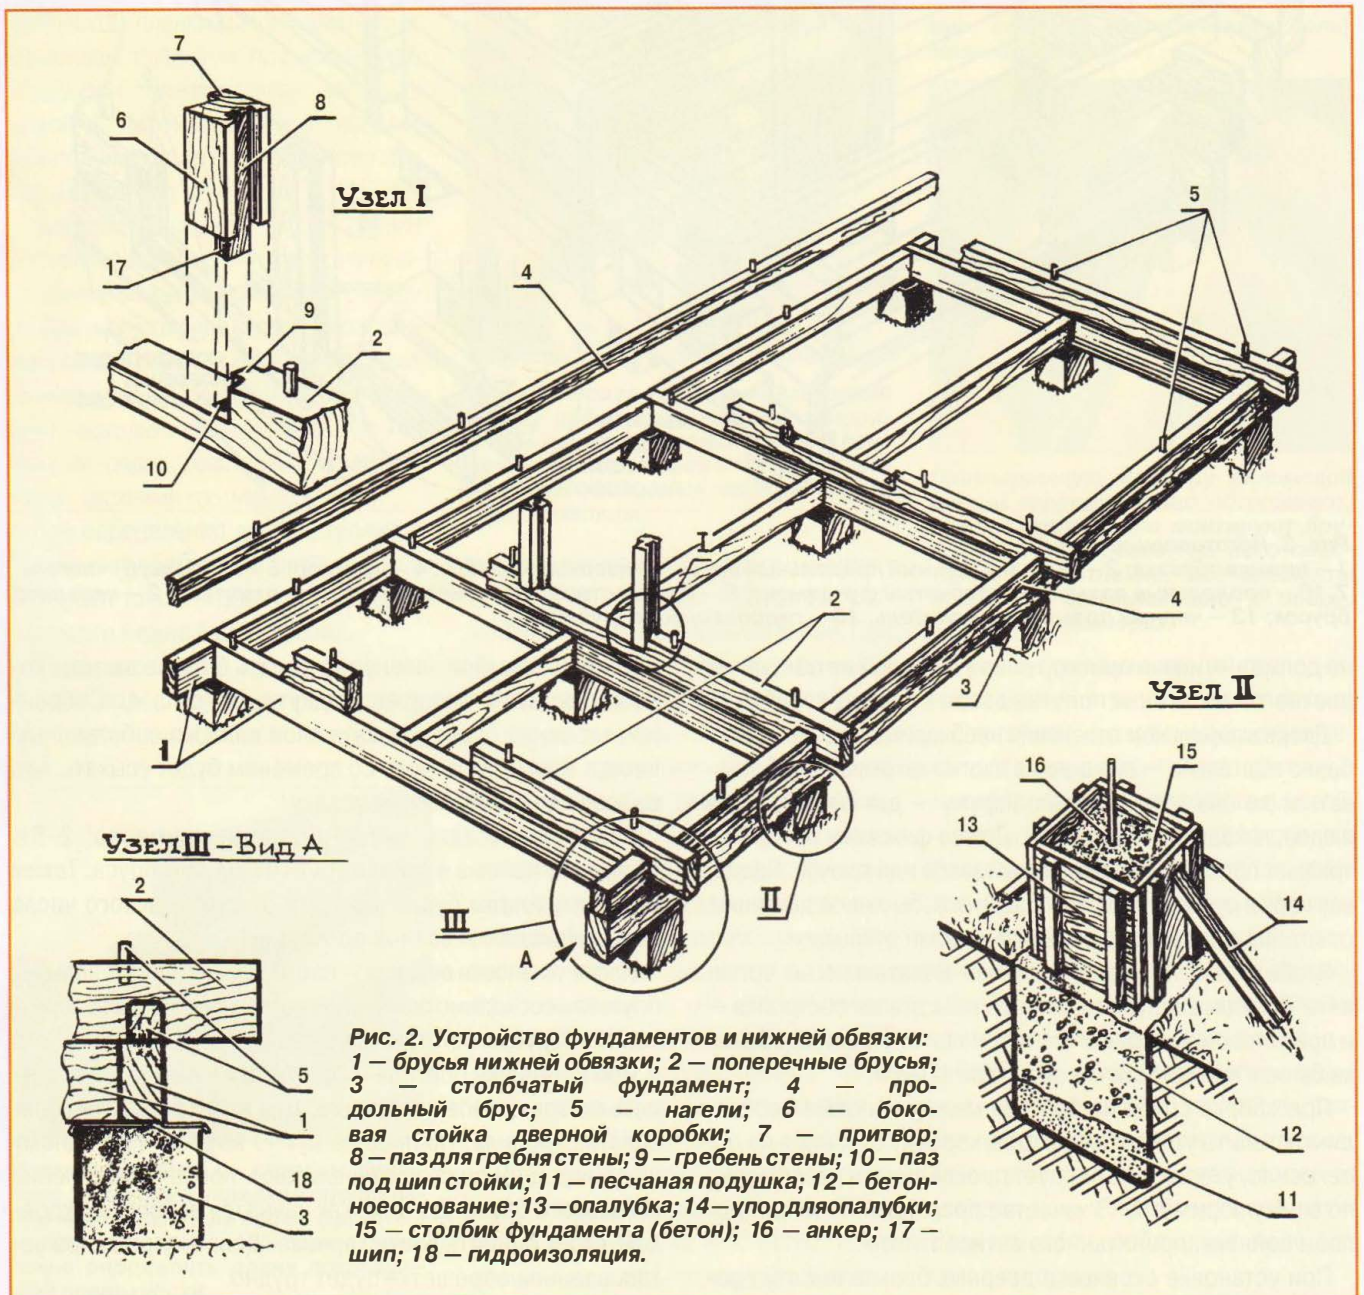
Устройство фундаментов и нижней обвязки: 1 — брусья нижней обвязки; 2 — поперечные брусья; 3 — столбчатый фундамент; 4 — продольный брус; 5 — нагели; 6 — боковая стойка дверной коробки; 7 — притвор; 8 — паз для гребня стены; 9 — гребень стены; 10 — паз под шип стойки; 11 — песчаная подушка; 12 — бетонное основание; 13 — опалубка; 14 — упор для опалубки; 15 — столбик фундамента (бетон); 16 — анкер; 17 — шип; 18 — гидроизоляция.
